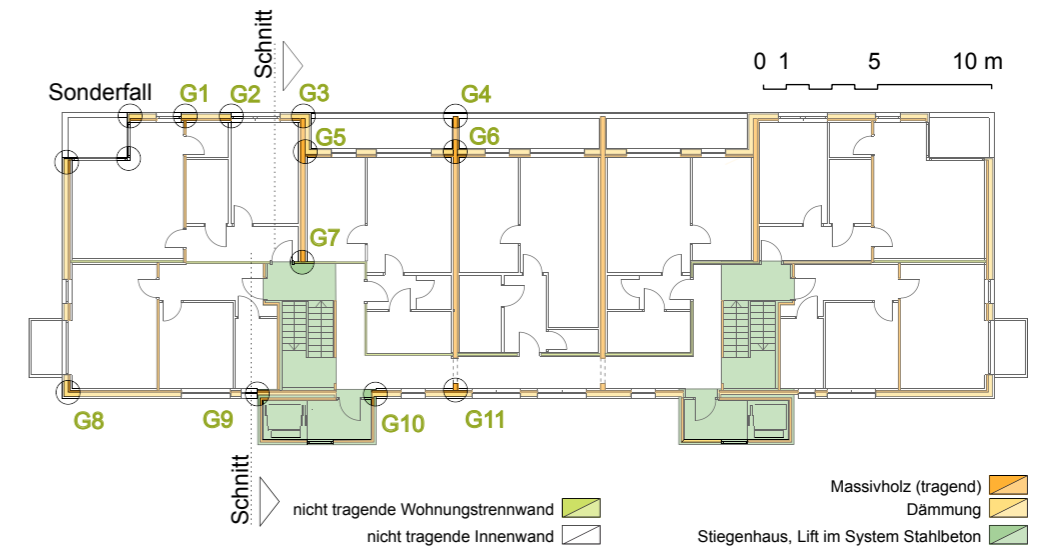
Aufstockungsgeschoss des Beispielgebäudes – Grundriss
